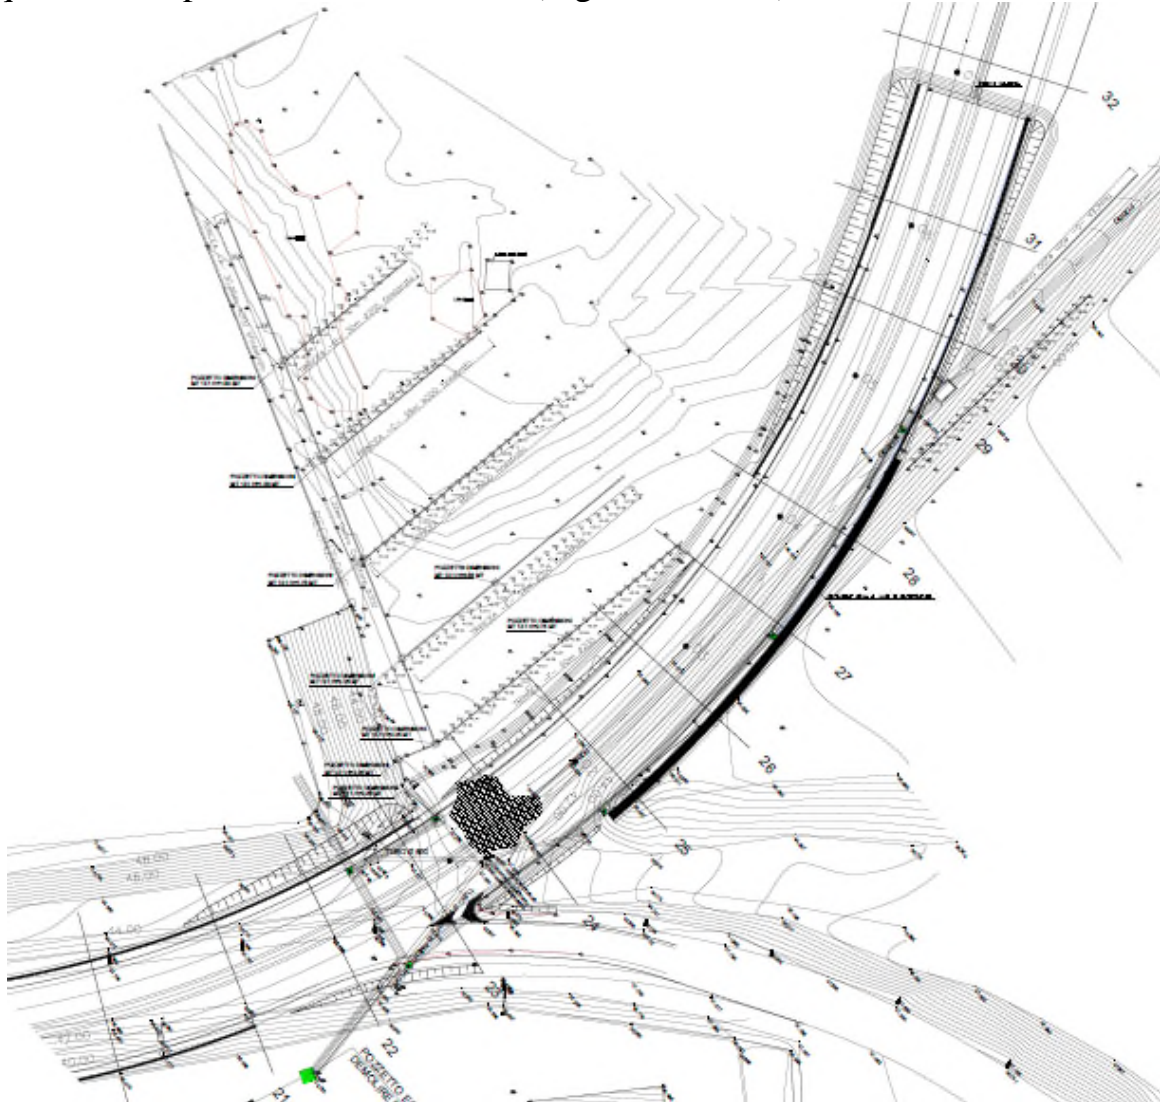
PLANIMETRIA TRINCEE DRENANTI
